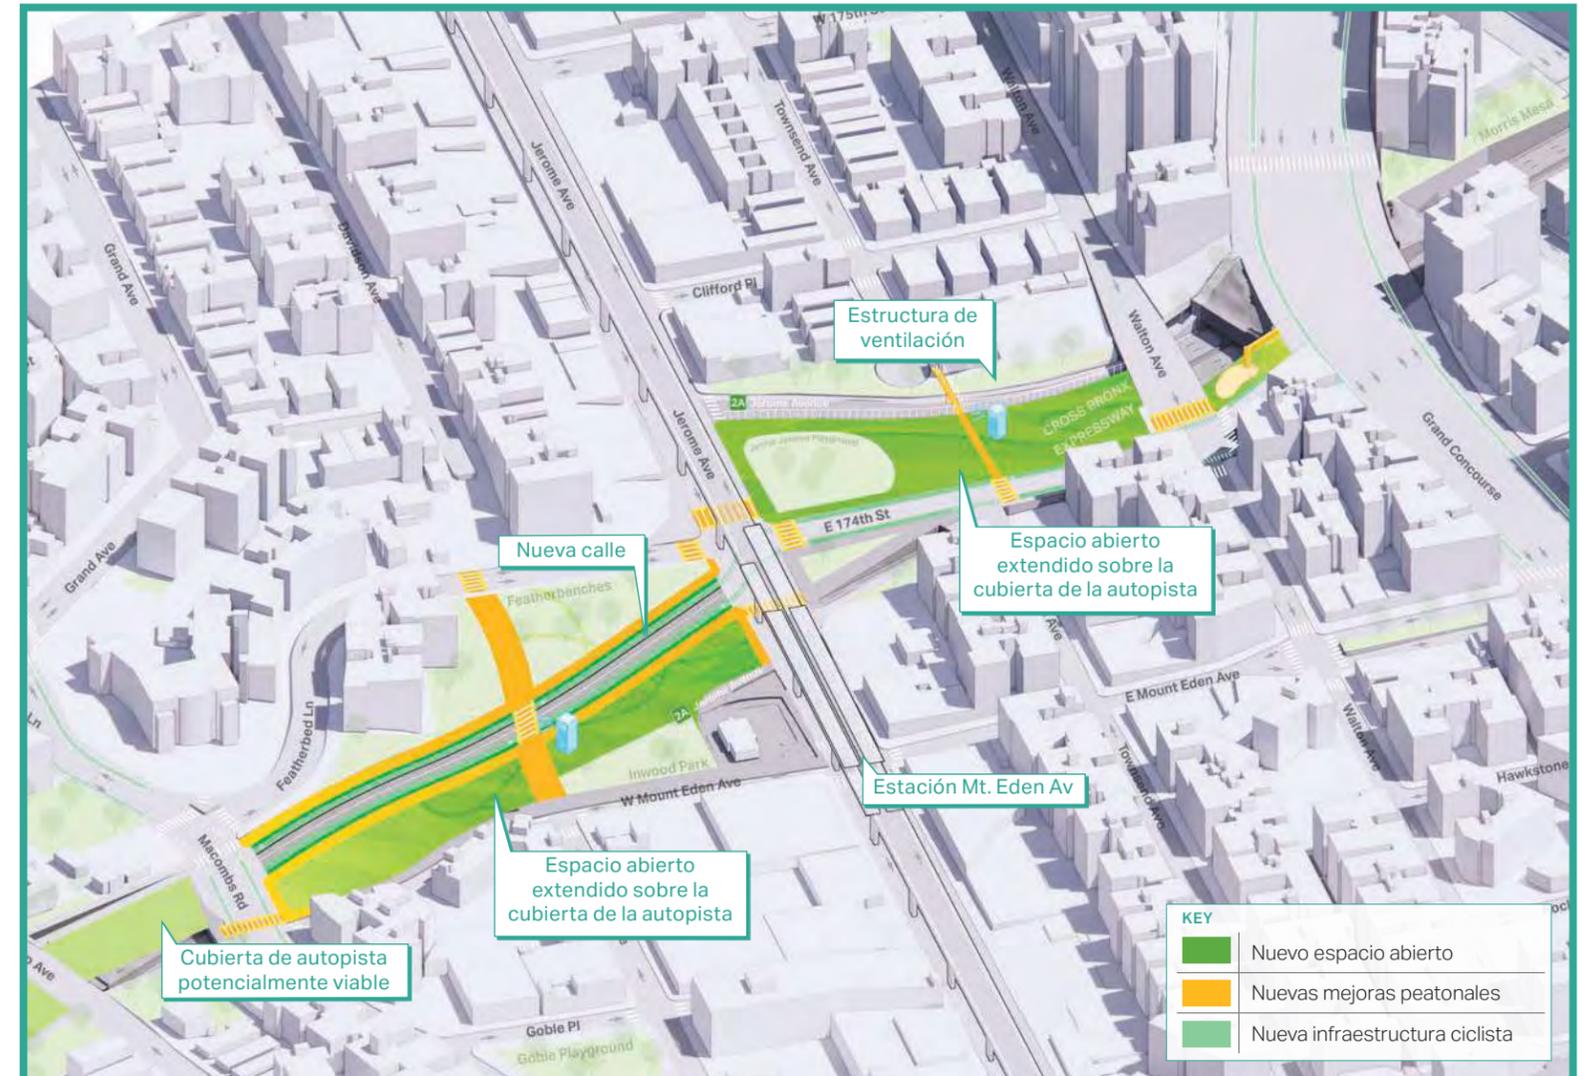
Concepto potencial de cubierta de autopista entre Macombs Road y Walton Avenue
